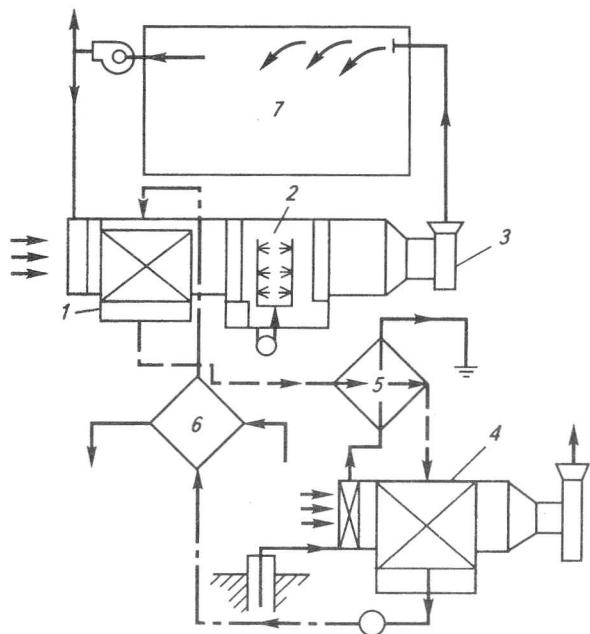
Схема холодоснабжения плодоовощехранилища на базе геотермальных источников:
